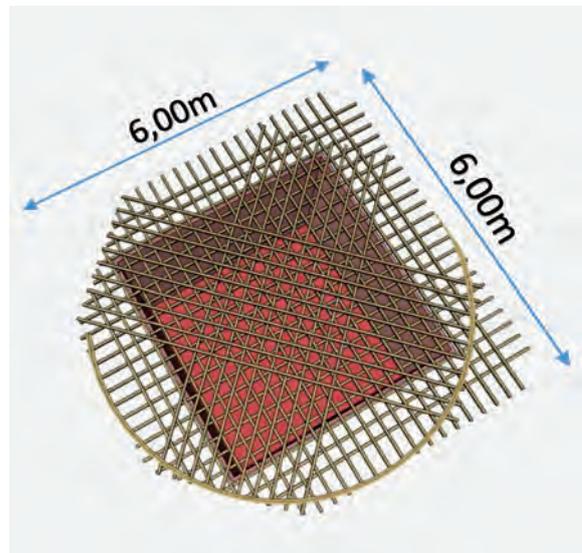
Deckenkonstruktion einer abgerundeten Decke.
